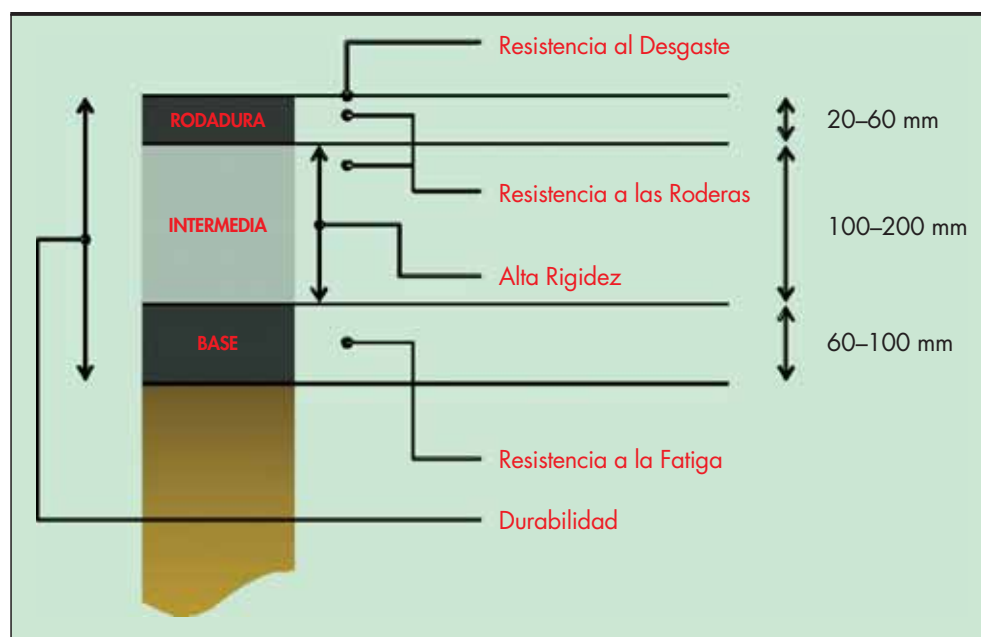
Esquema Tricapa de un Pavimento de Larga Duración.
